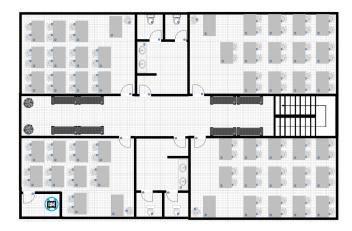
Planta do Primeiro Andar do Edifício 1
